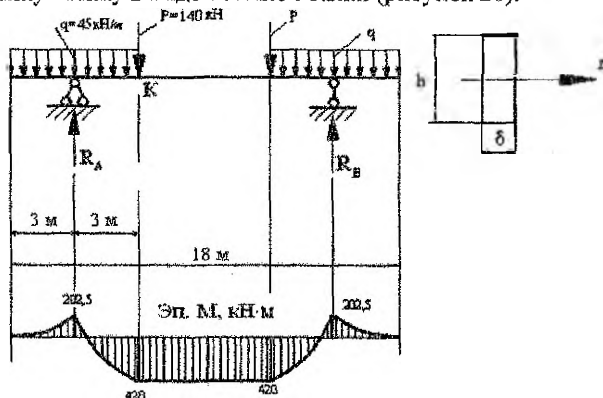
К расчету балки-стенки по балочной схеме (метод сопротивления материалов)
